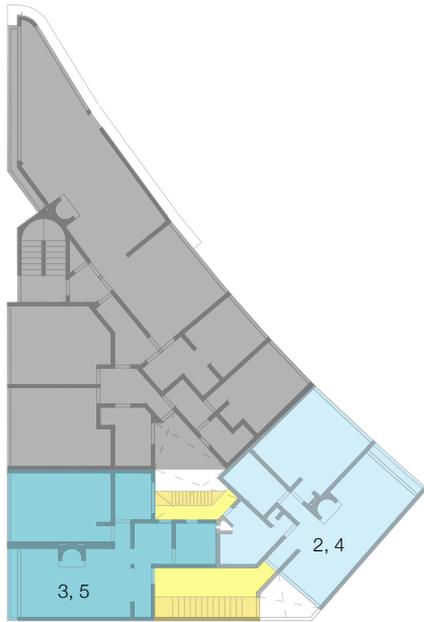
Fotografía del planta baja y escalera del Edificio 56
